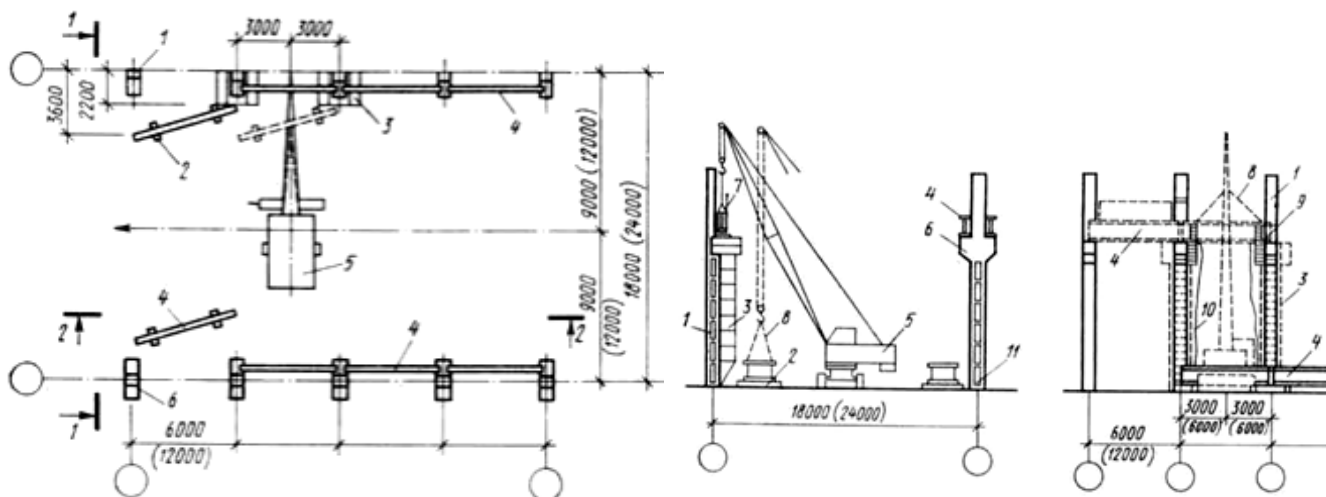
Схема установки подкрановых балок пролетом 6 и 12 м: 1 – колонна крайнего ряда; 2 – деревянная подкладка; 3 – приставная лестница; 4 – подкрановая балка; 5 – монтажный кран; 6 – колонна среднего ряда; 7 – стойка со страховочным канатом; 8 – строп; 9 – лестница монтажная; 10 – оттяжка из пенькового каната; 11 – место крепления приставной лестницы к колонне стальным канатом диаметром 13 мм.
